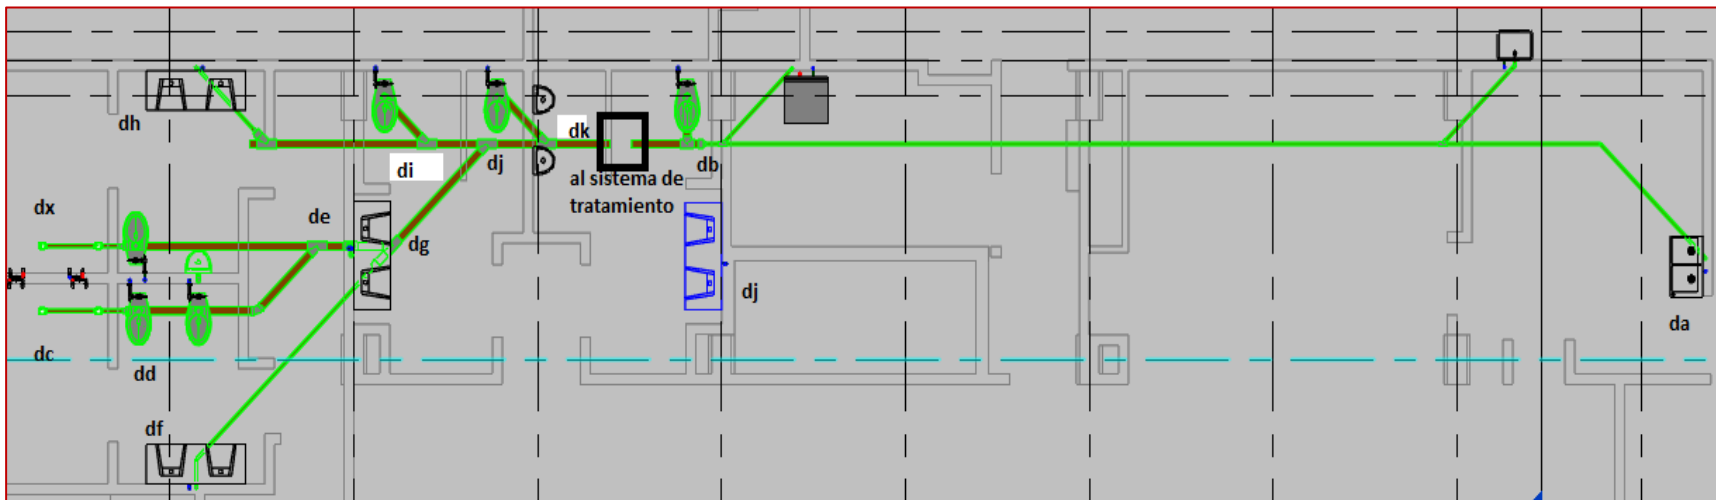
Propuesta de trayectoria de drenaje sanitario en planta baja
